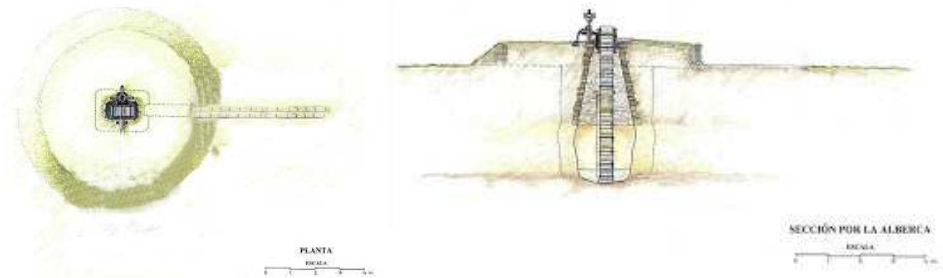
Planta 6.1.4.2-1
